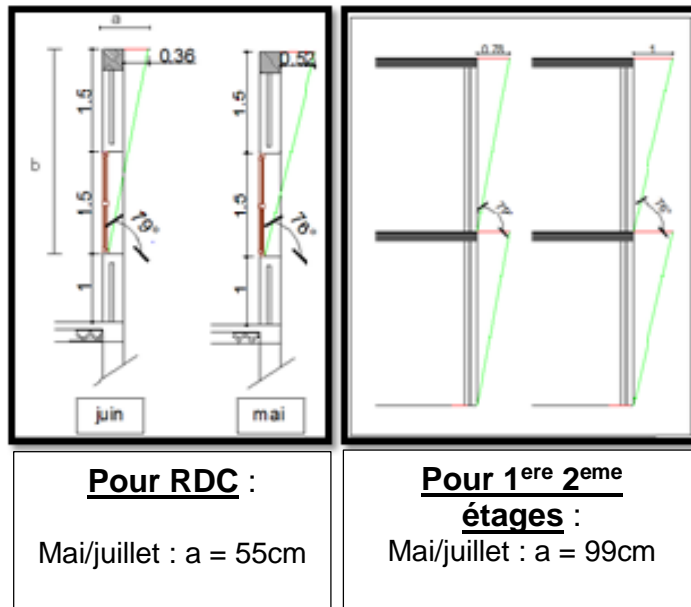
schéma sur les brises soleil de la façade sud, AUTEURS
